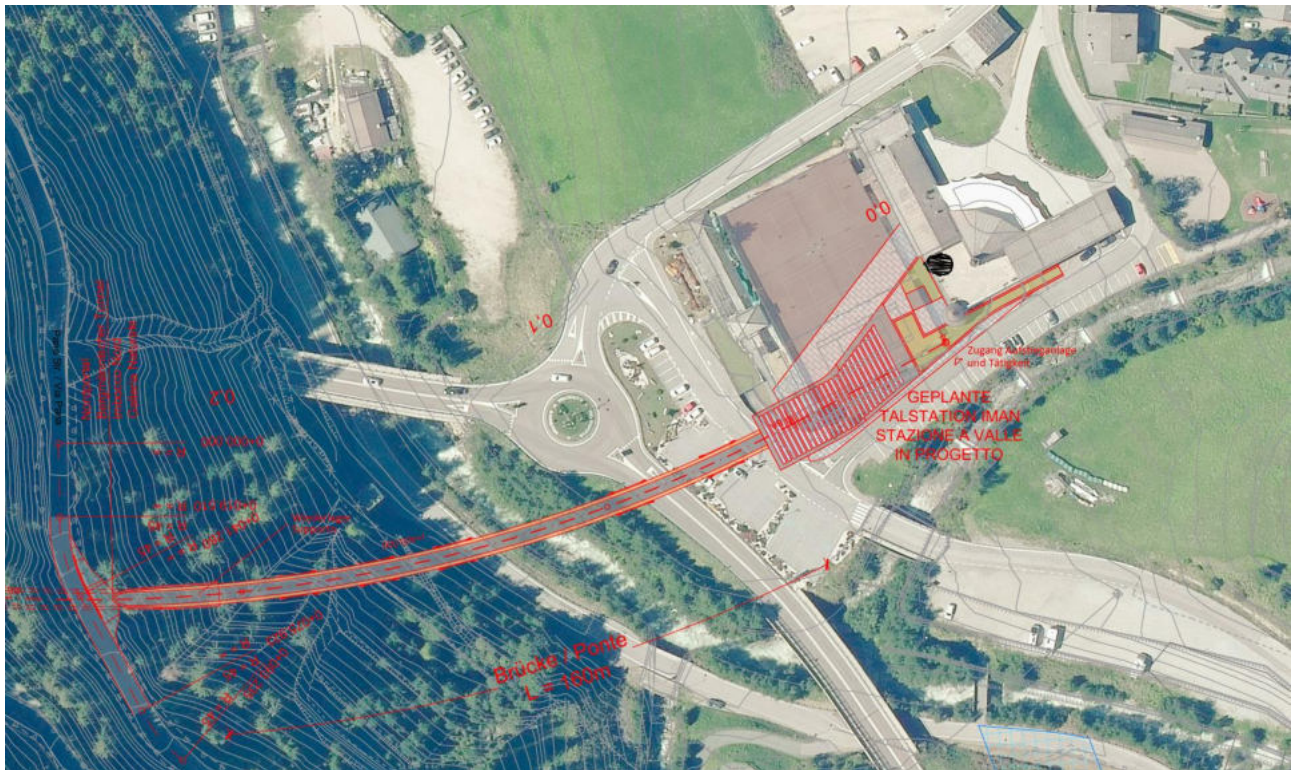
Auszug Lageplan mit der geplanten Talstation IMAN
